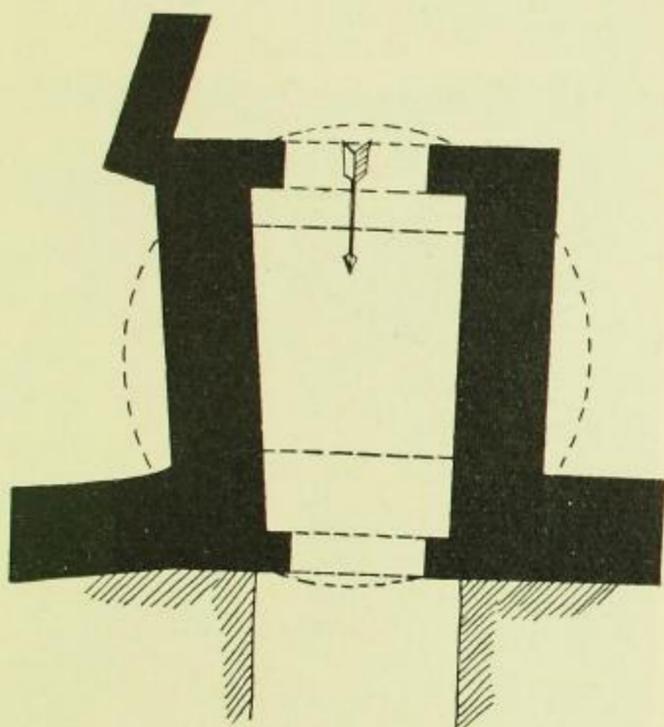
Nikolaiturm, Grundriß des Erdgeschosses.
